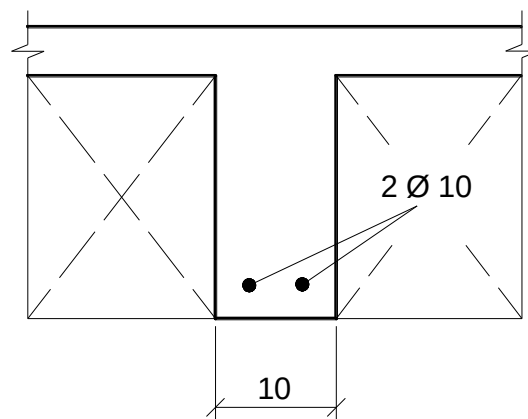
Detalhamento da armadura de flexão na seção transversal da nervura.
